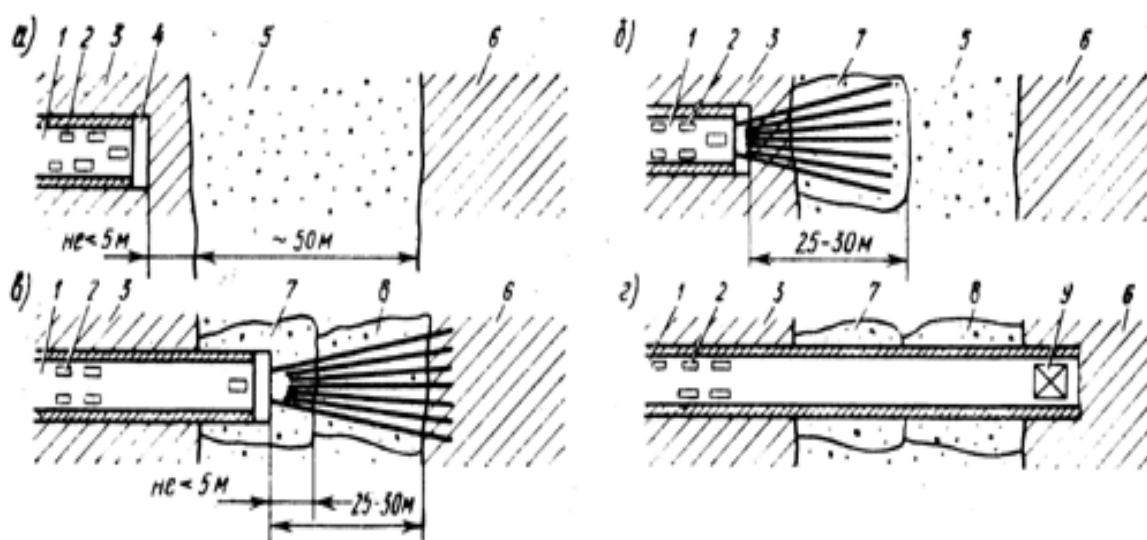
Схема химического закрепления грунта при проходке горизонтальной выработки:
